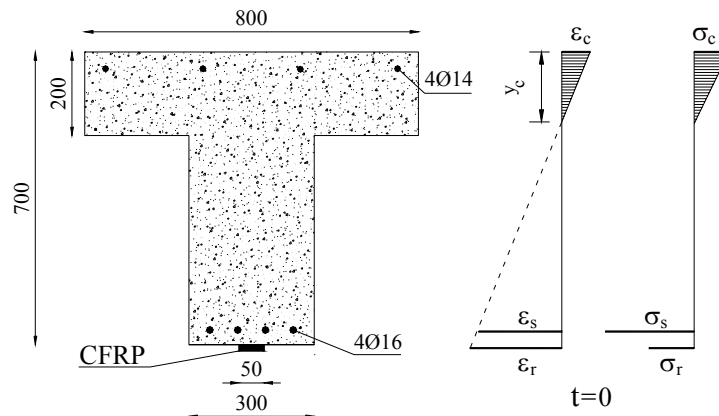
Sezione retta della trave placcata con CFRP (dimensioni in mm)
